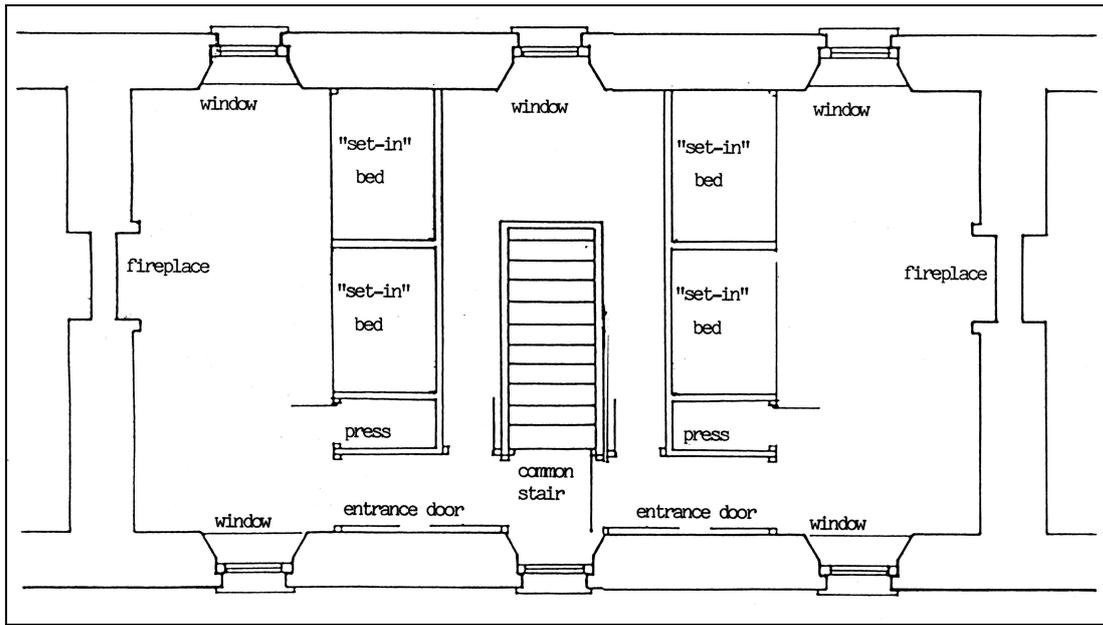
Plan au sol de logement ouvrier à New Lanark
